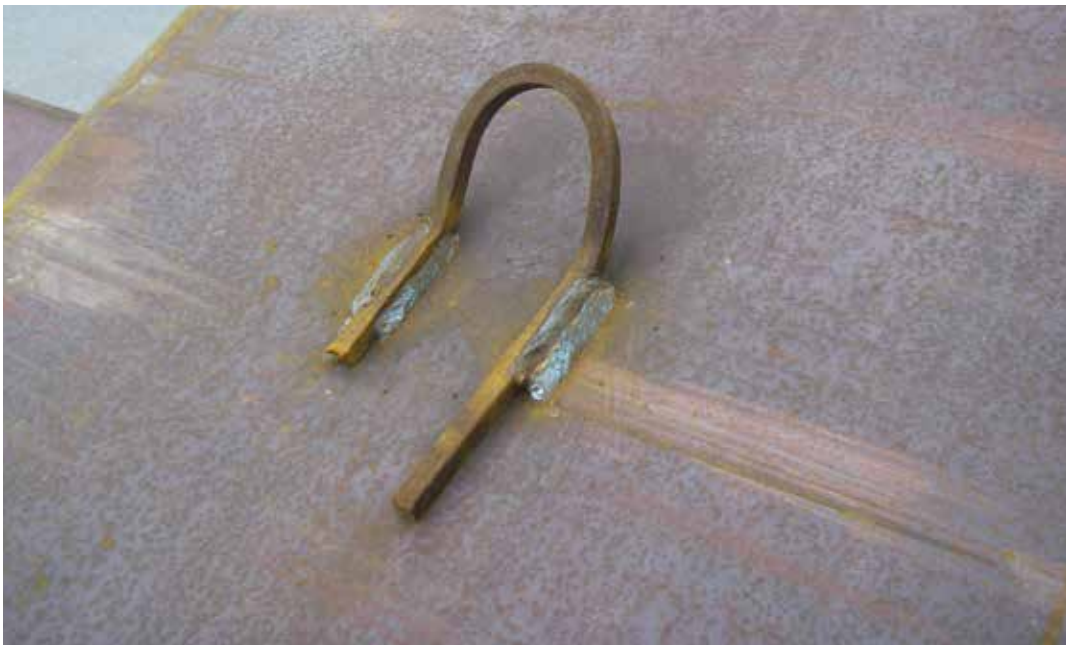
Anschlagpunkt – Quadratprofil min. 8/8 mm – 4 x 6 cm Schweißlänge – Tragkraft 10 kN (Foto WLV)
